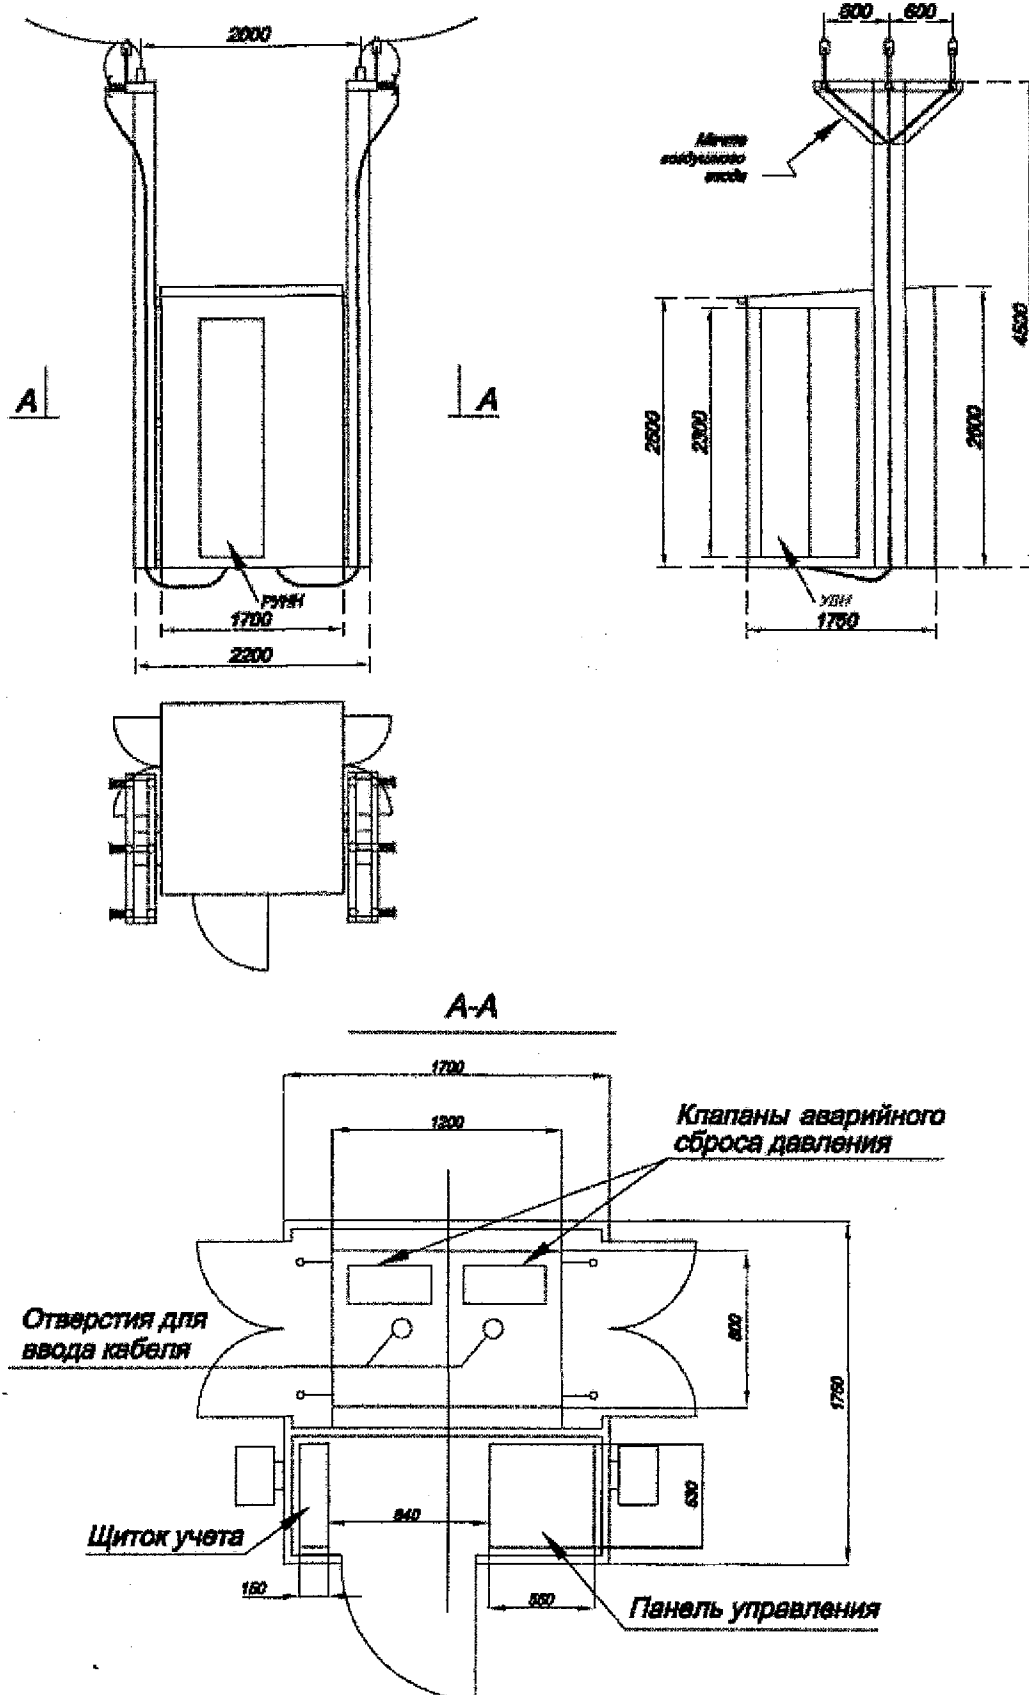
Внешний вид, компоновка и габаритные размеры КРН-АТ-ПС
